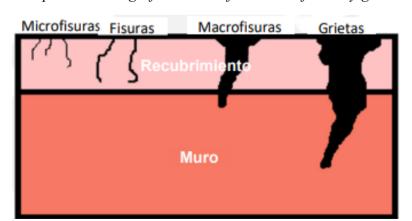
Representación gráfica de clasificación de fisuras y grietas
